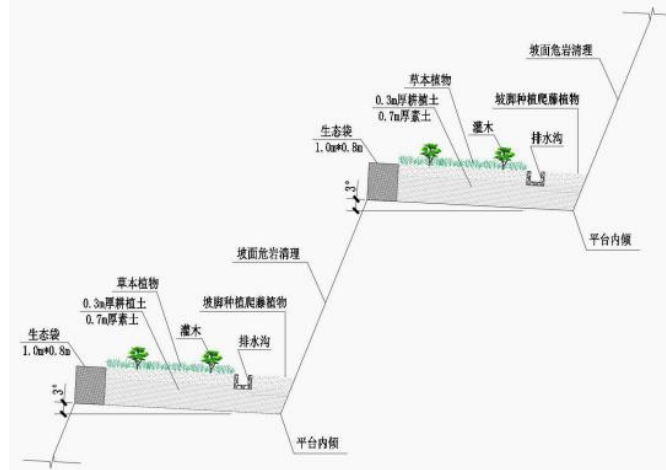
终了平台植树复垦截面示意图（单位：mm）
